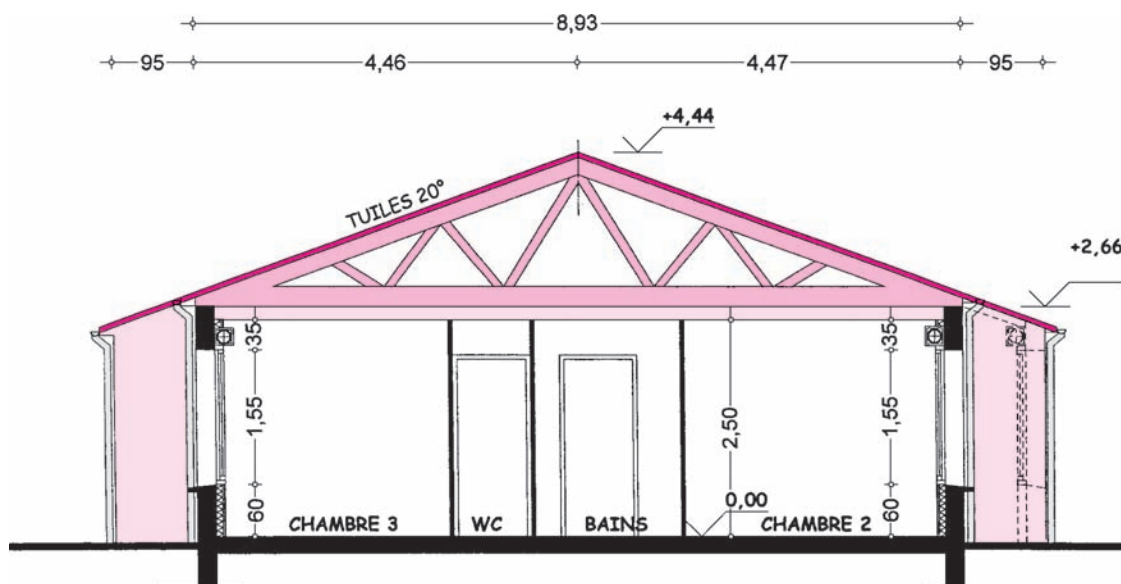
Coupe transversale sur chambre 2 et 3 du pavillon
